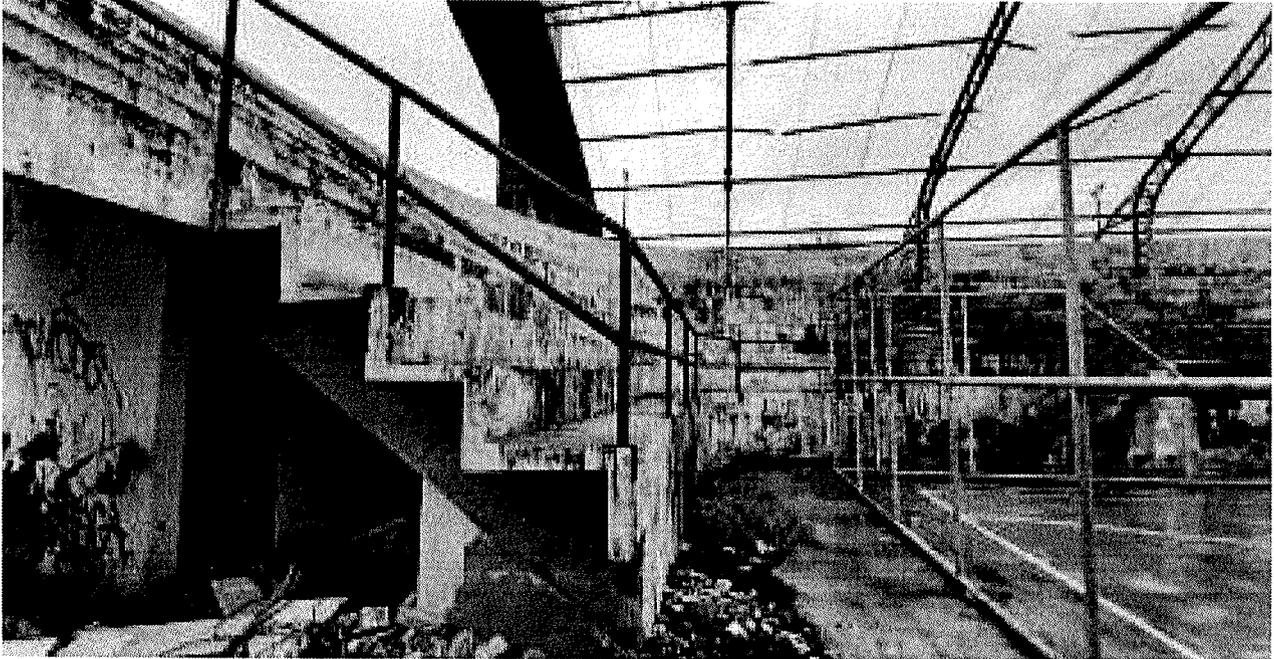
Detalhes das alvenarias, estrutura metálica e esquadrias verificados em visita técnica.
